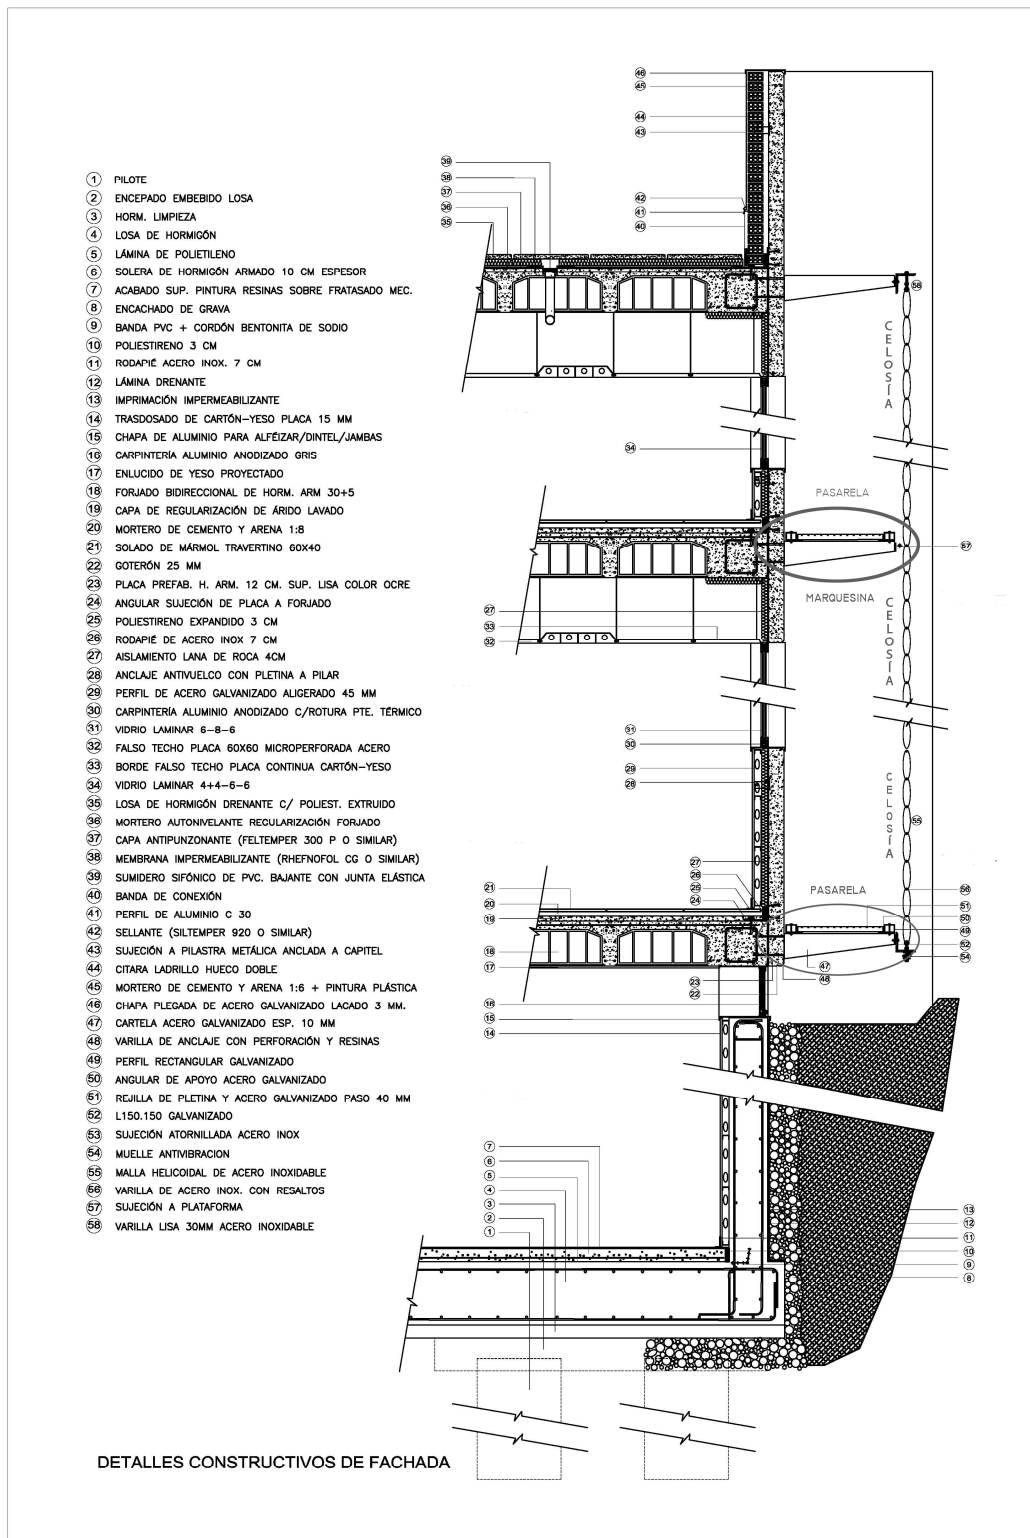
Detalle constructivo de fachadas tipo (Proyecto)
